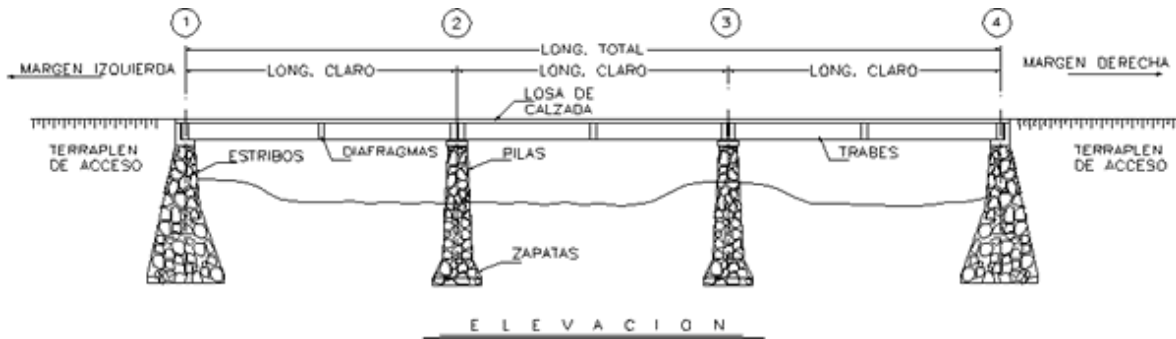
Partes del puente (Elevación). www.construaprende.com/tesis02/img/image193.gif
